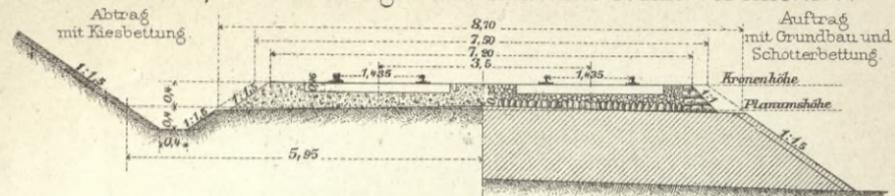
Bahnkörper zweigl. Hauptbahnen. Eisenb.-Direkt. Breslau.
